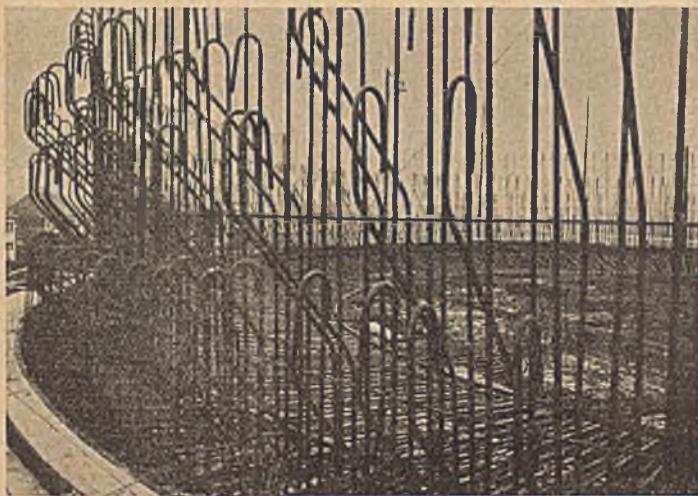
Wasserturm Stoppenberg bei Essen. Anschluß der Behälterwände an den Boden.
